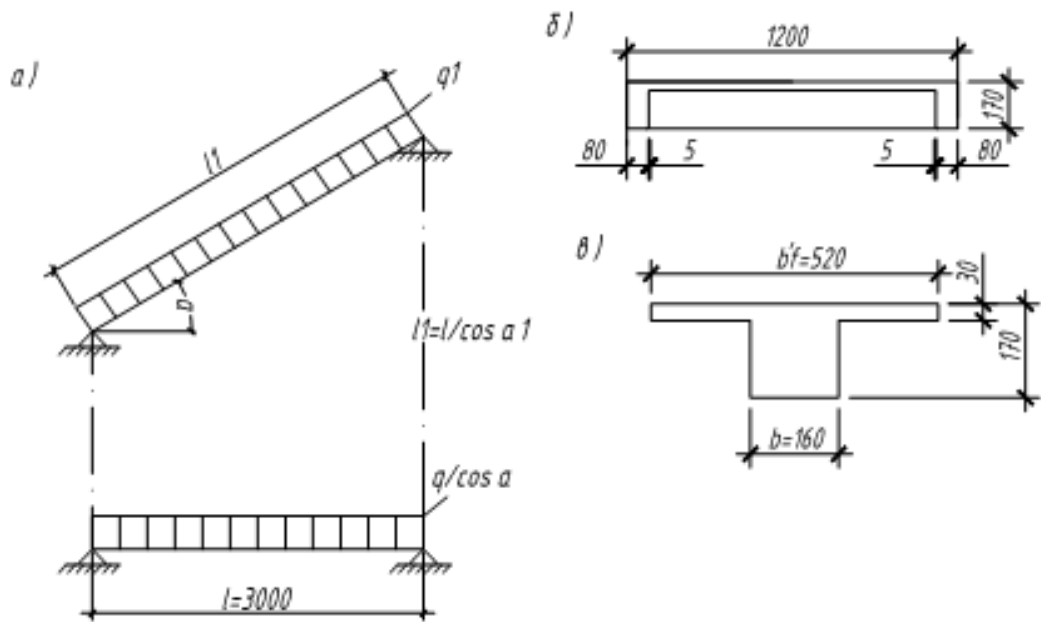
К расчету лестничного марша: а- расчетная схема; б, в- фактическое и приведенное поперечные сечения
